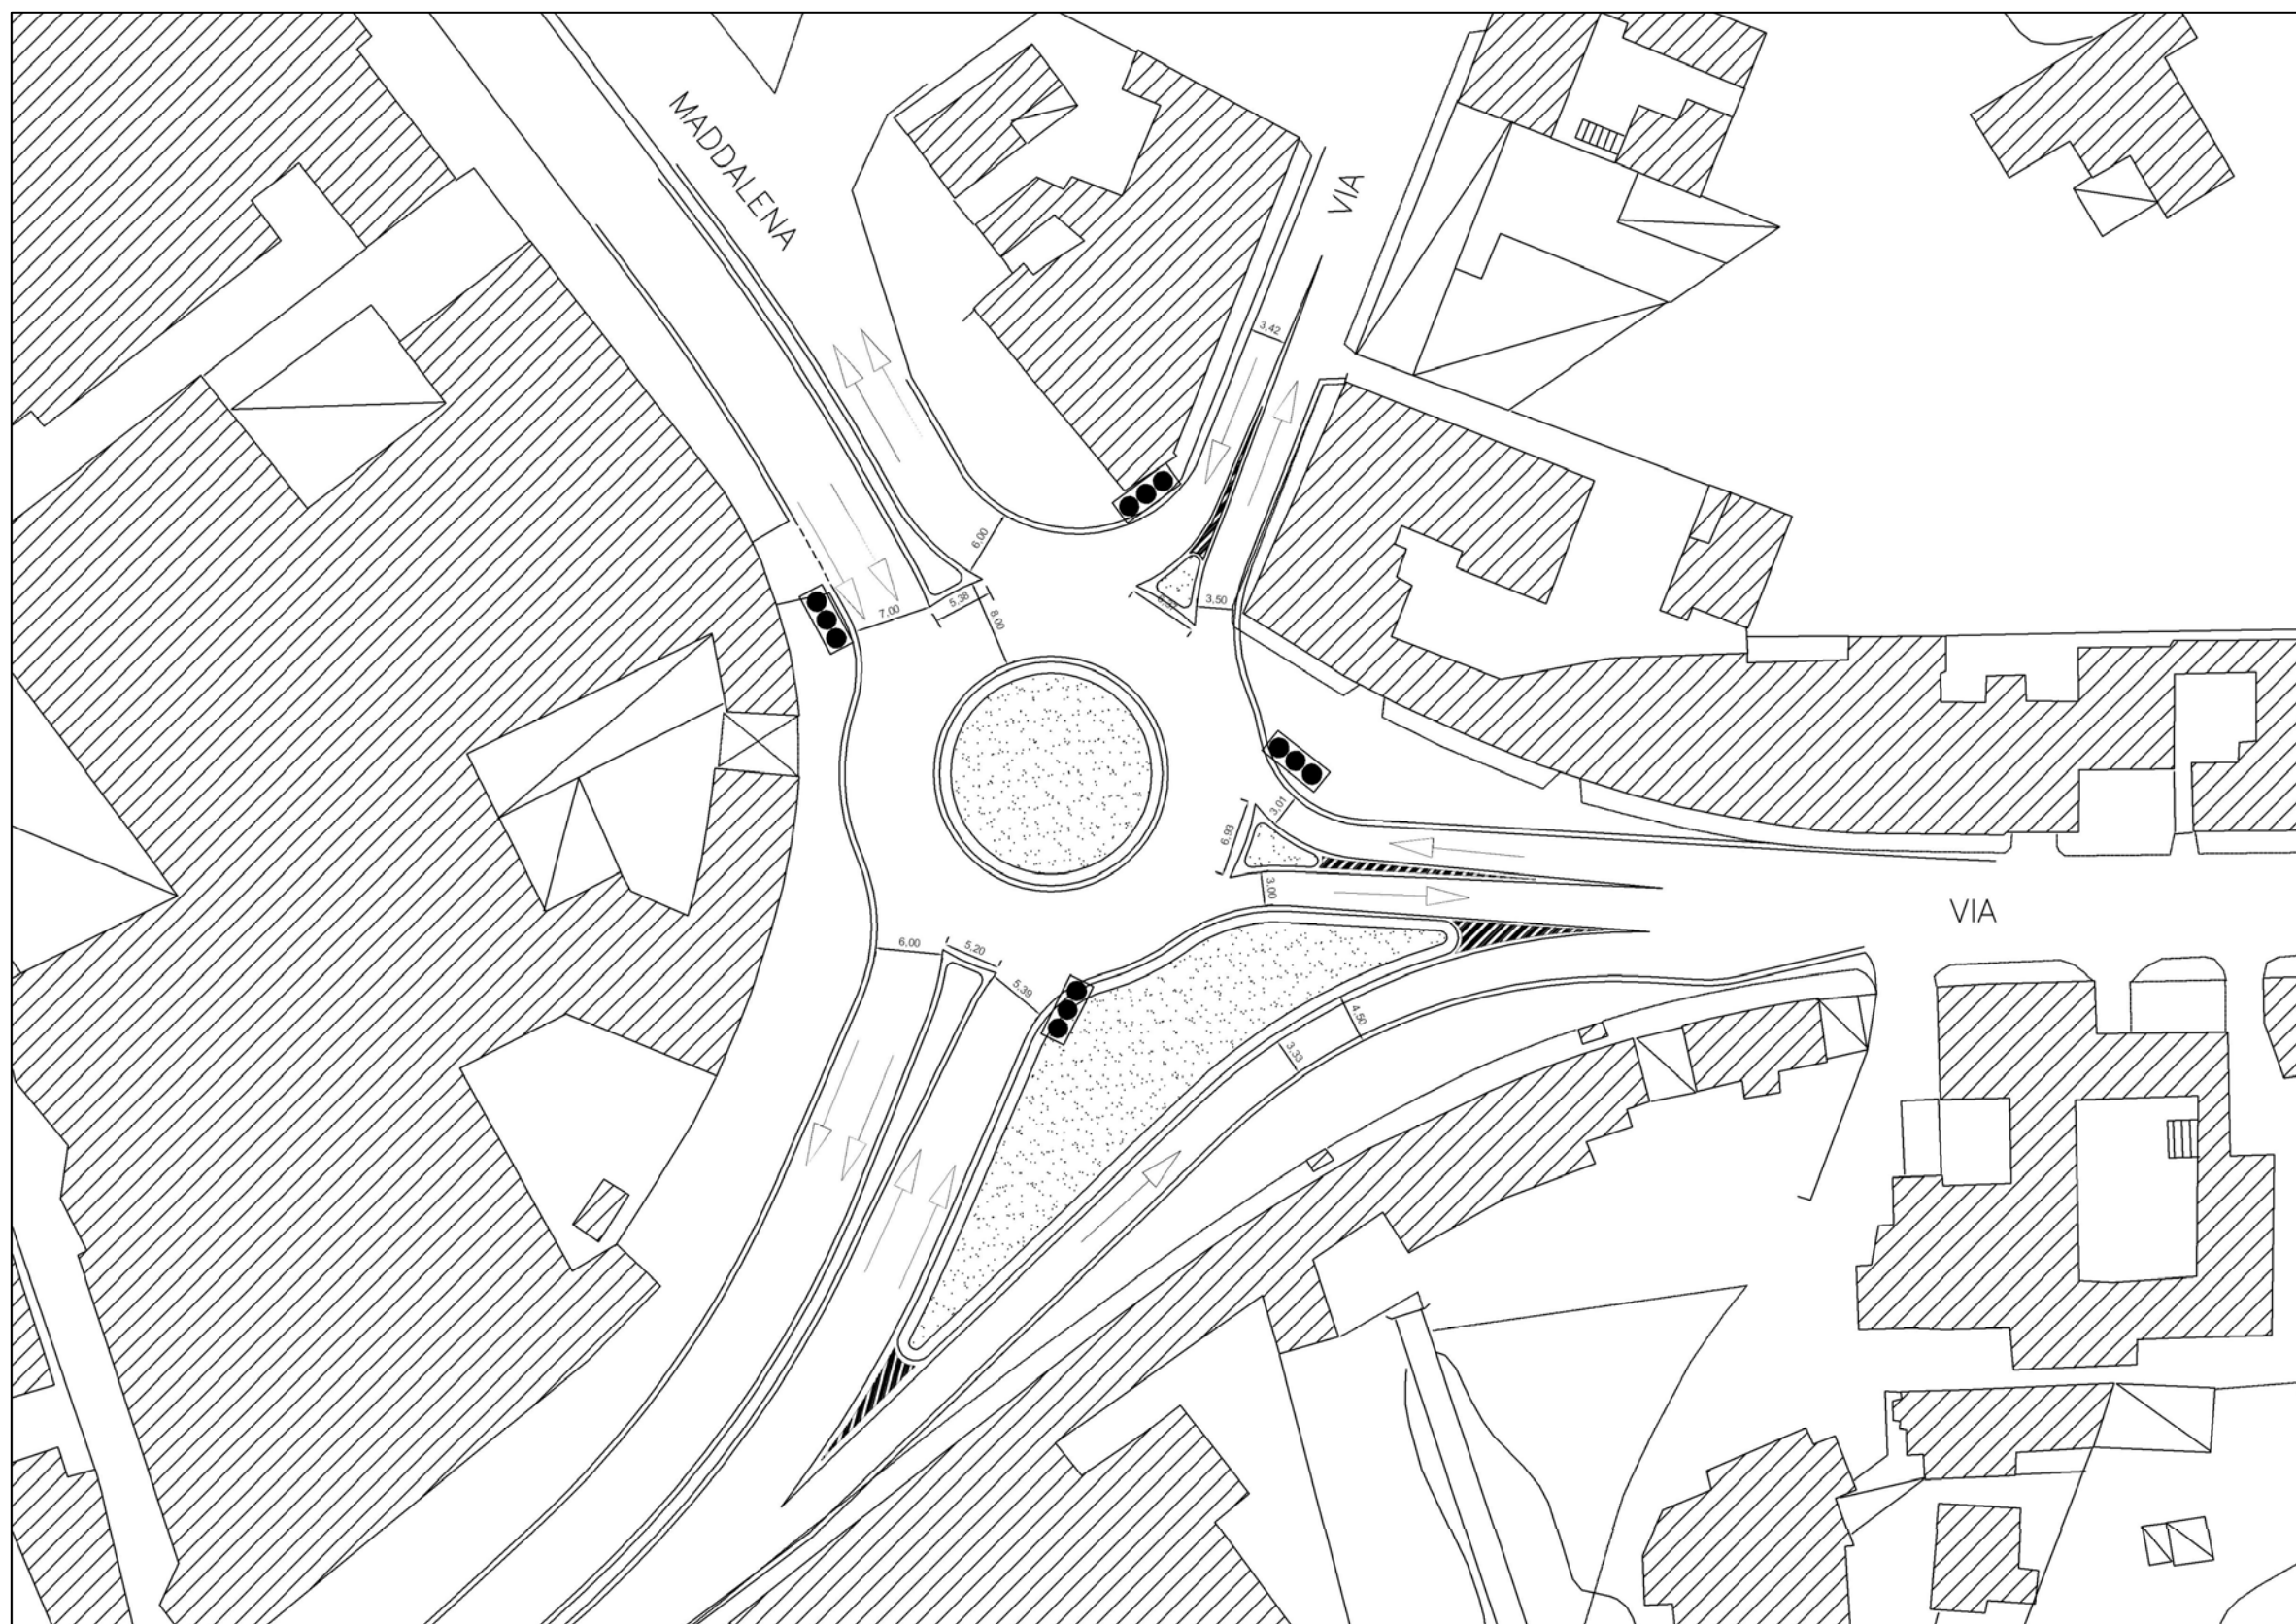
Largo Santa Maria del Pianto - Scenario di Progetto
